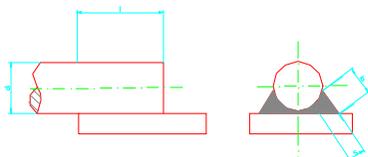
钢筋与钢板搭接焊接头
